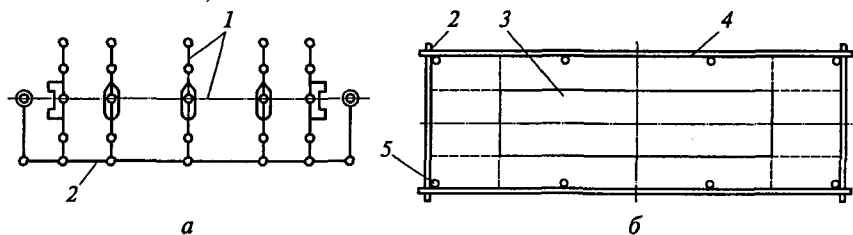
Схемы к разбивке осей и контуров фундаментов:
